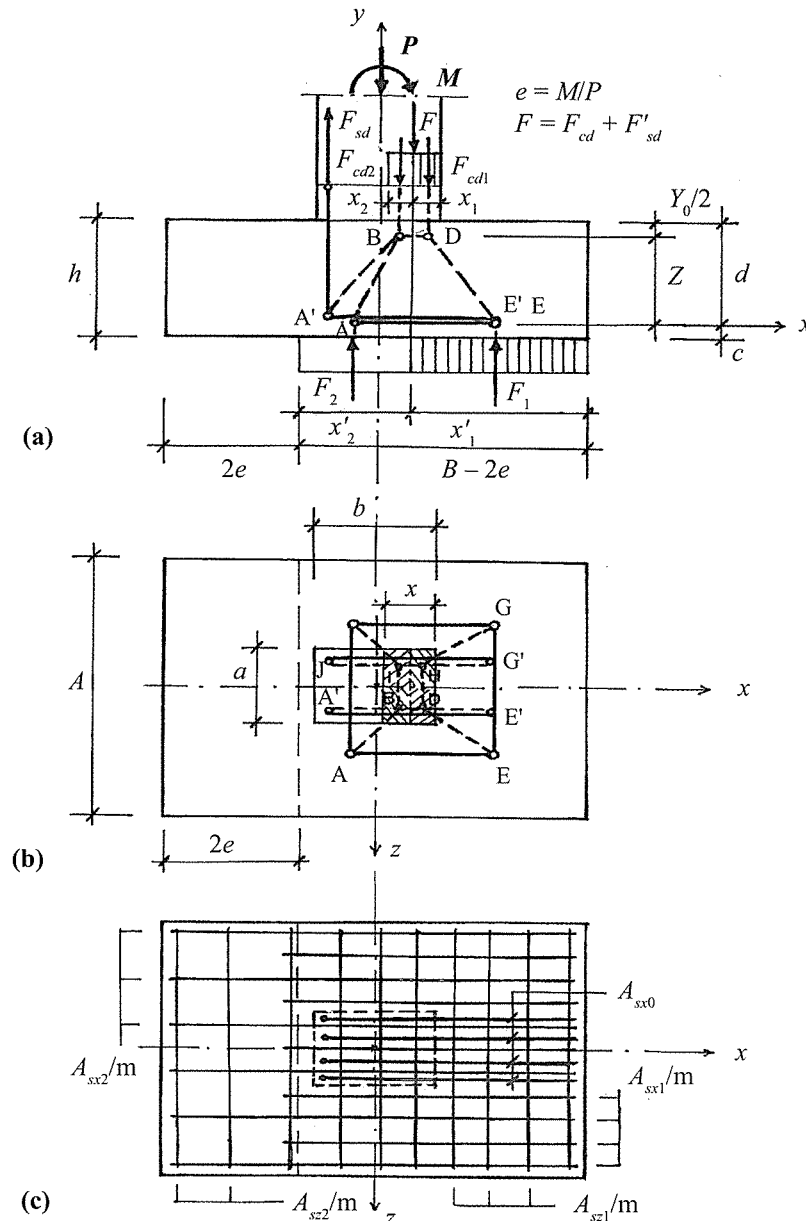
Modélisation B-T pour une semelle rigide sous poteau en flexion composée (dans le plan xoy) de section partiellement comprimée avec aciers tendus ($e < B/6$) : a) coupe verticale suivant le plan xoy ; b) vue en plan du modèle tridimensionnel; c) schéma des armatures associé au modèle.
